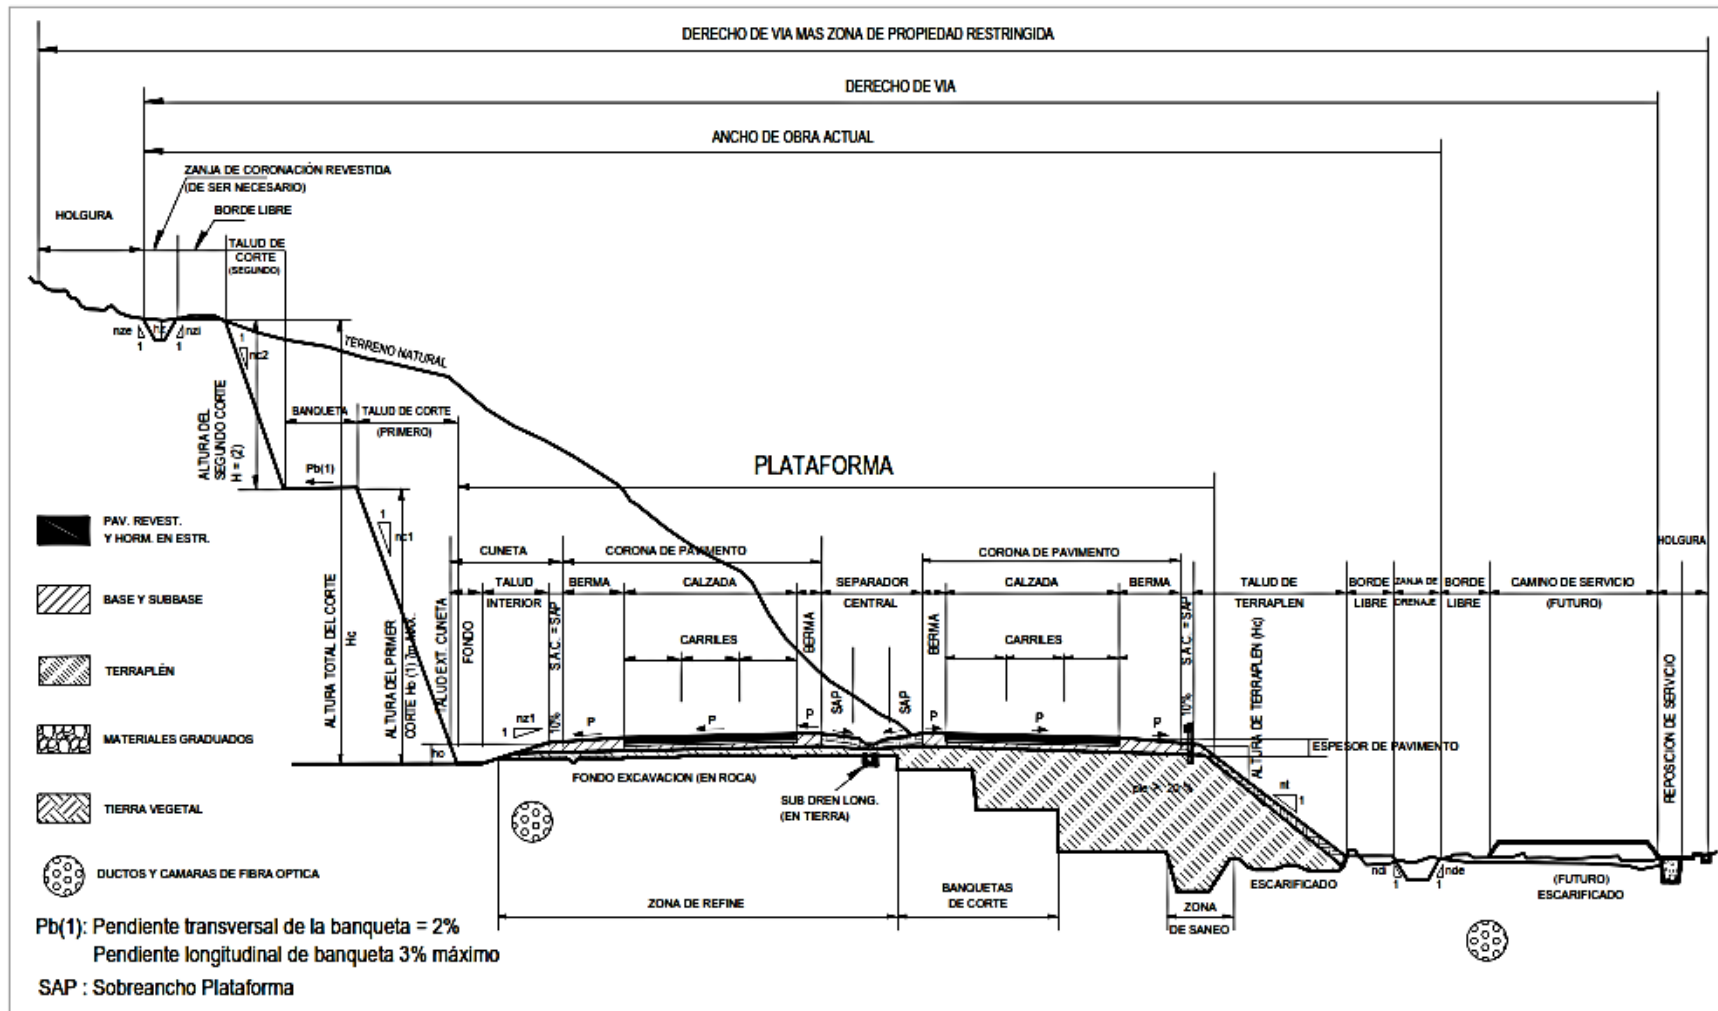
Sección transversal tipo a media ladera para una autopista en tangente
